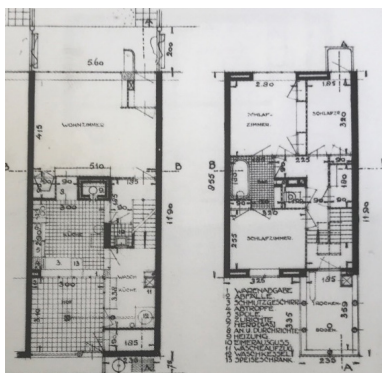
Planta das habitações geminadas de J. J. P. Oud, 1927
